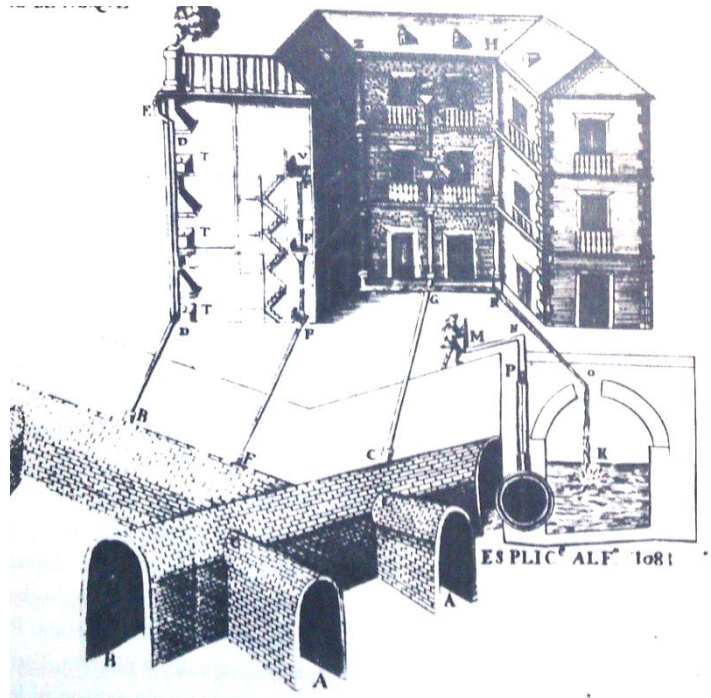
Proyecto de Alcantarillado, de José de Arce
